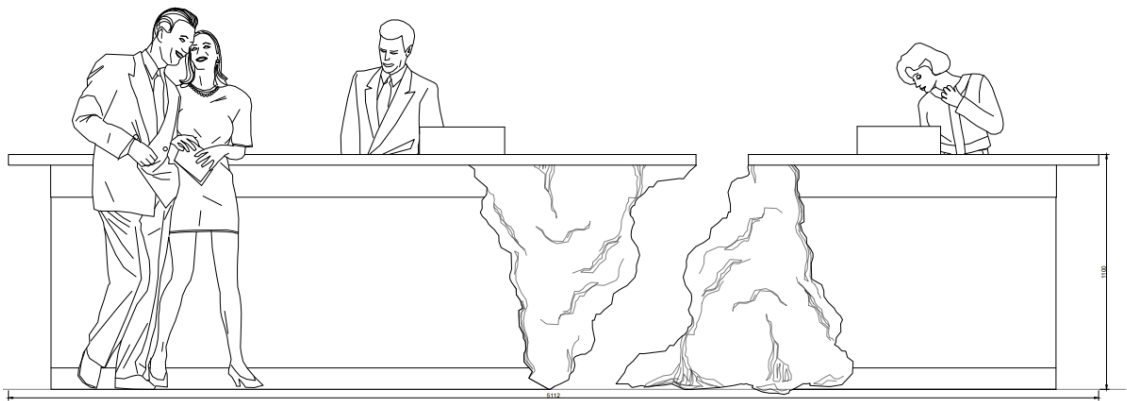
I - Desenho de Conjunto, Balão de Bar e de Alojamento
